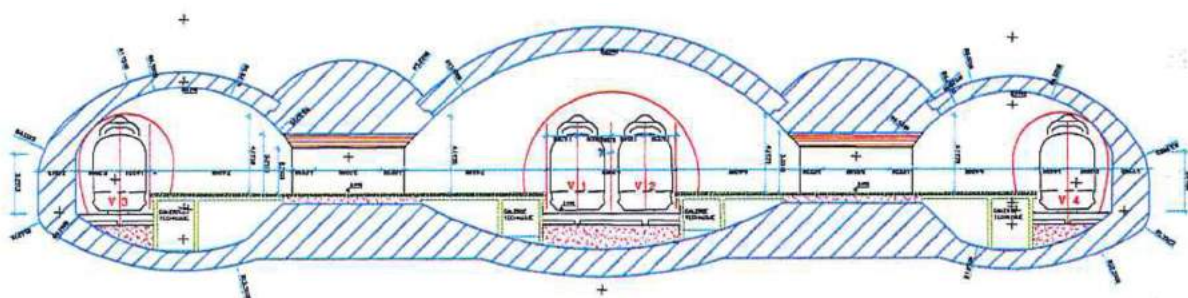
Coupe transversale de principe gare Haussmann Saint-Lazare au droit des quais
